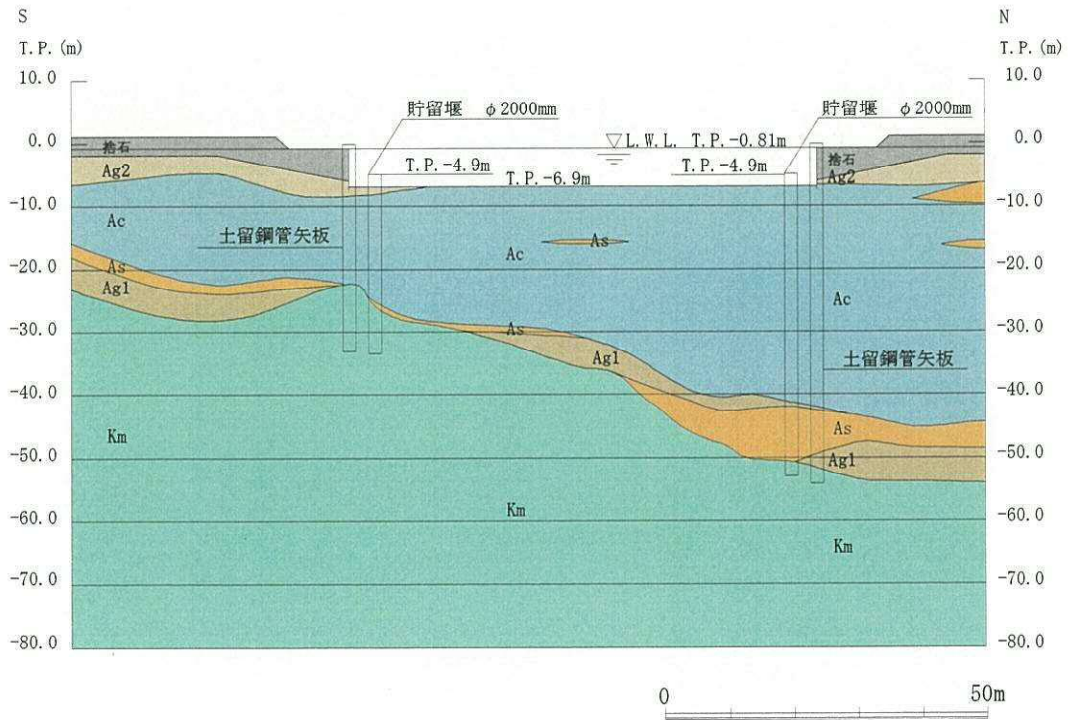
土留鋼管矢板の断面図 (NS-1)
